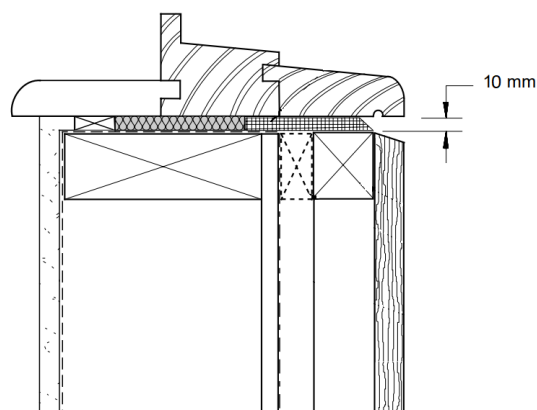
Junta entre a caixilharia e o *timber-frame* preenchida com material isolante e vedante
